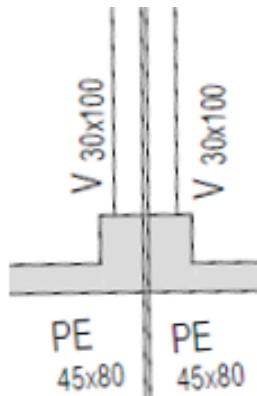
DETALHE TÍPICO DOS PILARES (EIXOS E6 E E14)
